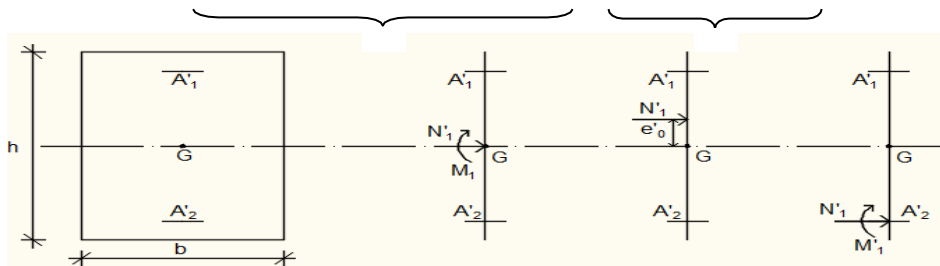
Position de N'1 M'1 et M1 sur la section transversale.
